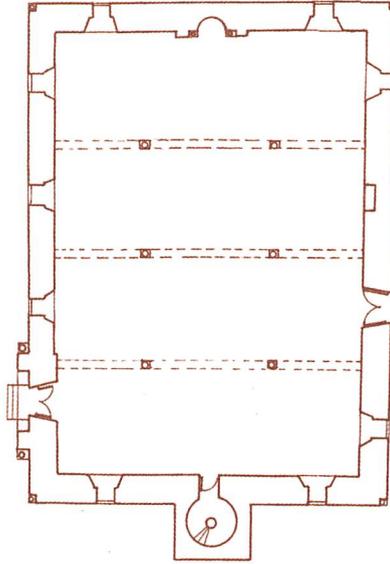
المسقط الأفقى لمسجد الوكيل بسمخراط
